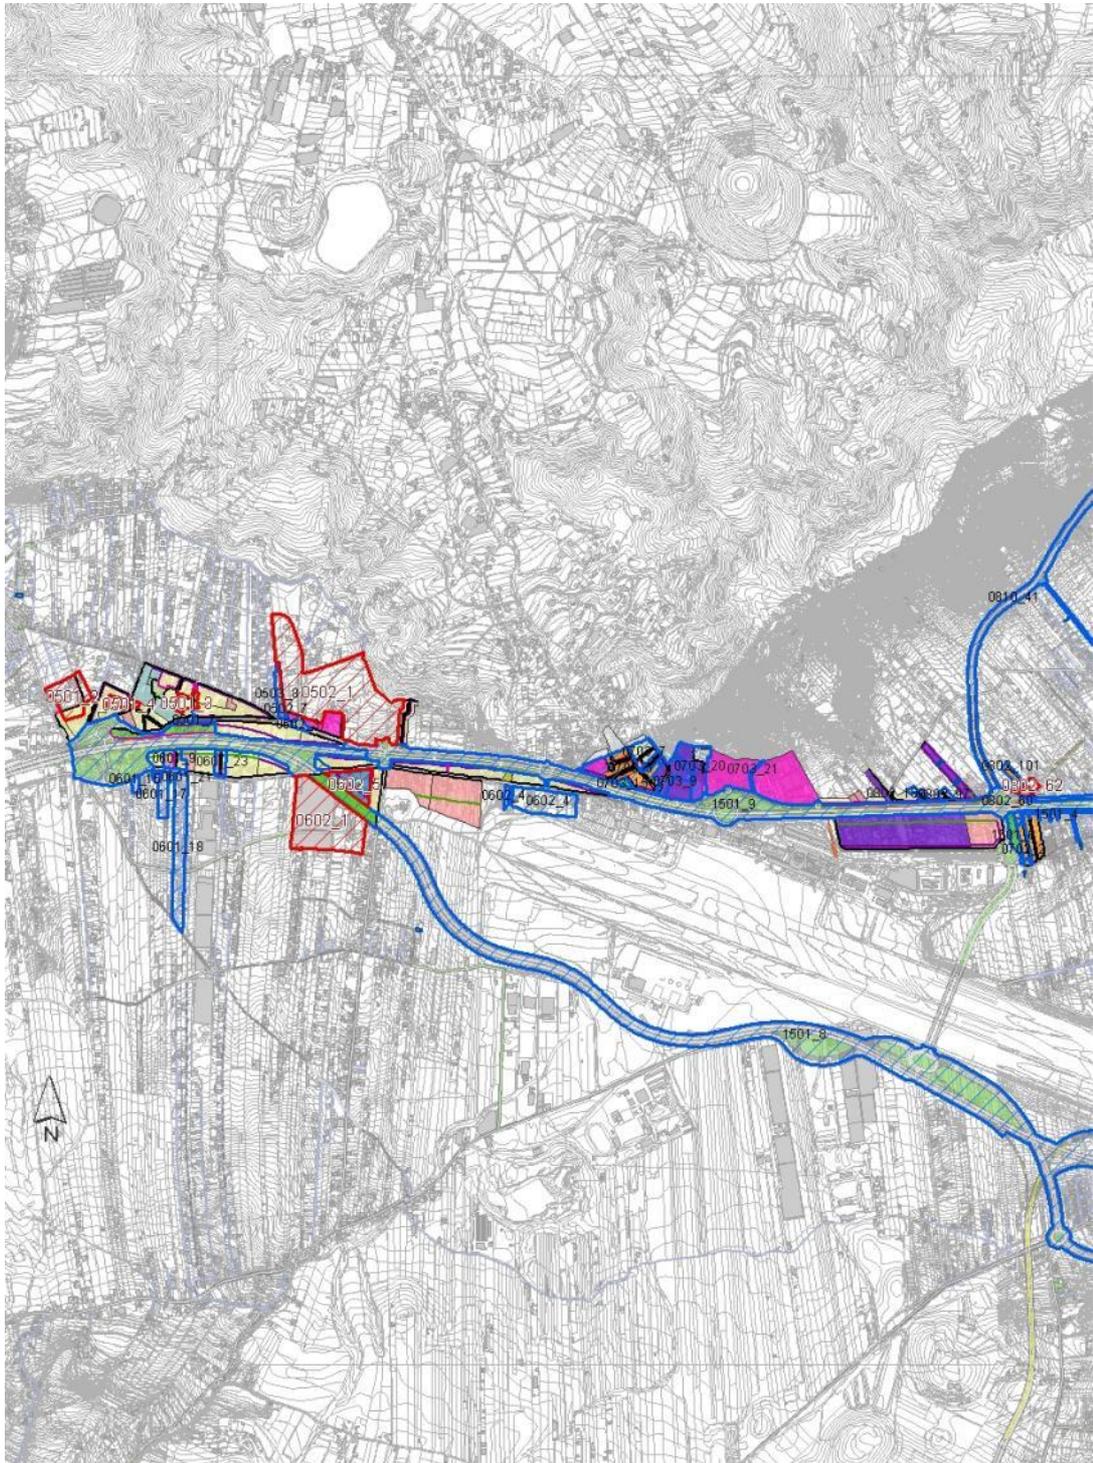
Planta General de la TF-5 (entre el enlace de Guamasa y la glorieta acceso al Aeropuerto)
